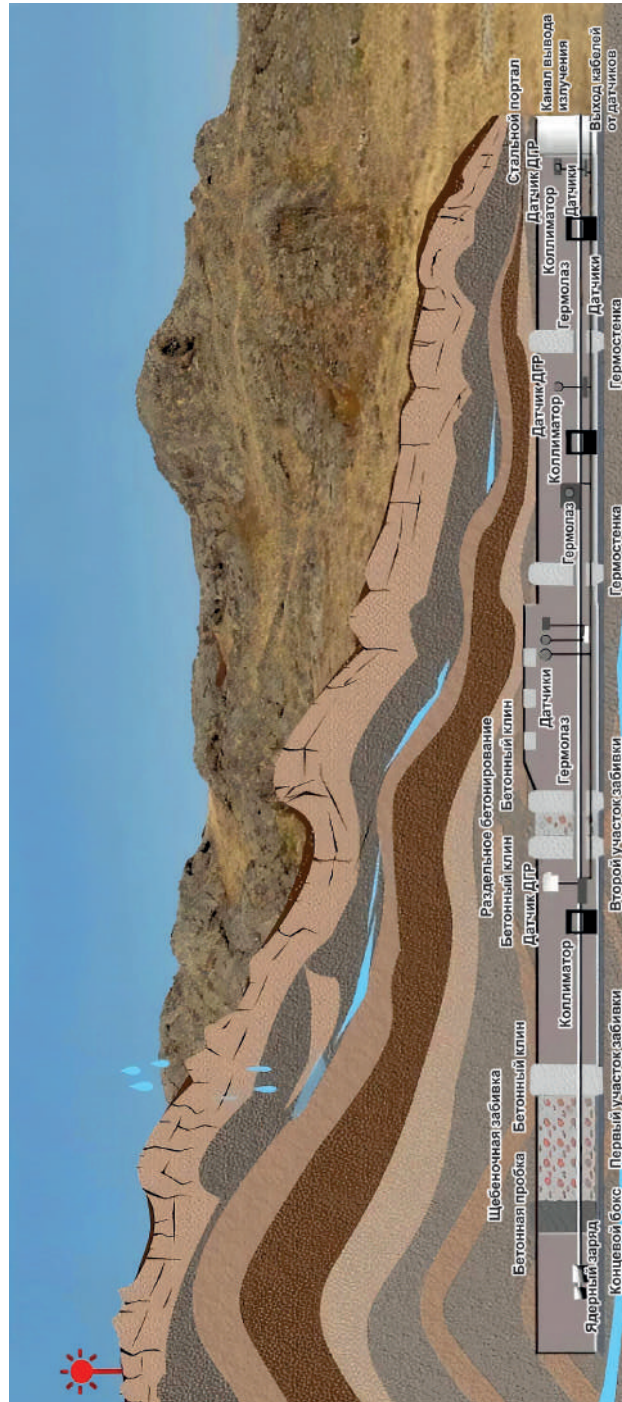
Поперечный разрез штольни до проведения испытания
